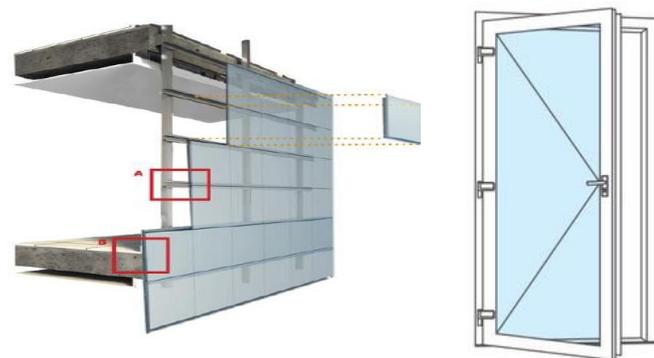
Uso de aislamiento exterior con fachada ventilada compuesto por lana mineral
